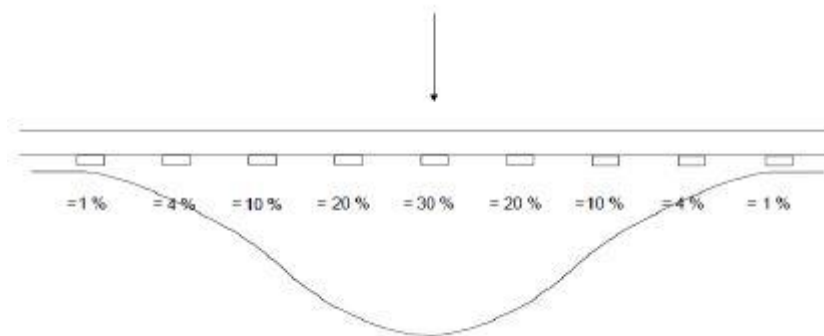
Carregamento tipo nas travessas adjacentes ao ponto de aplicação de uma carga estática (Adaptado de: (10))
